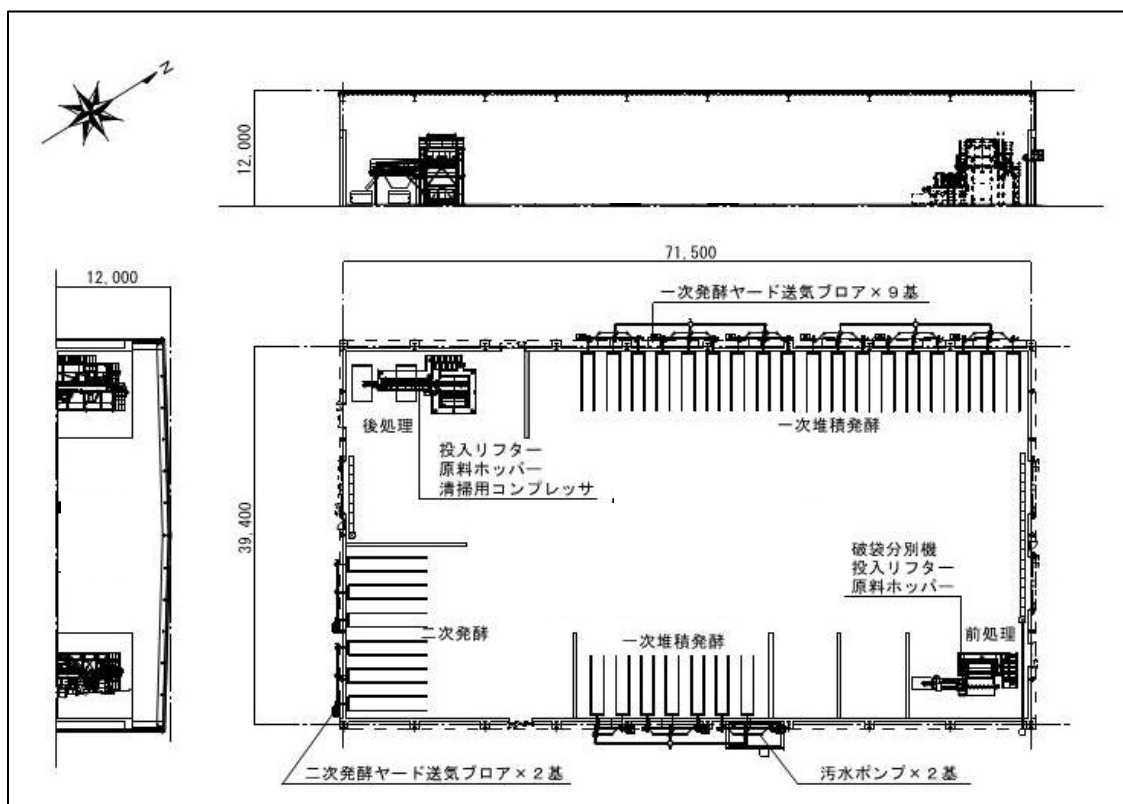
設備機器の平面図・断面図（堆肥化施設）
